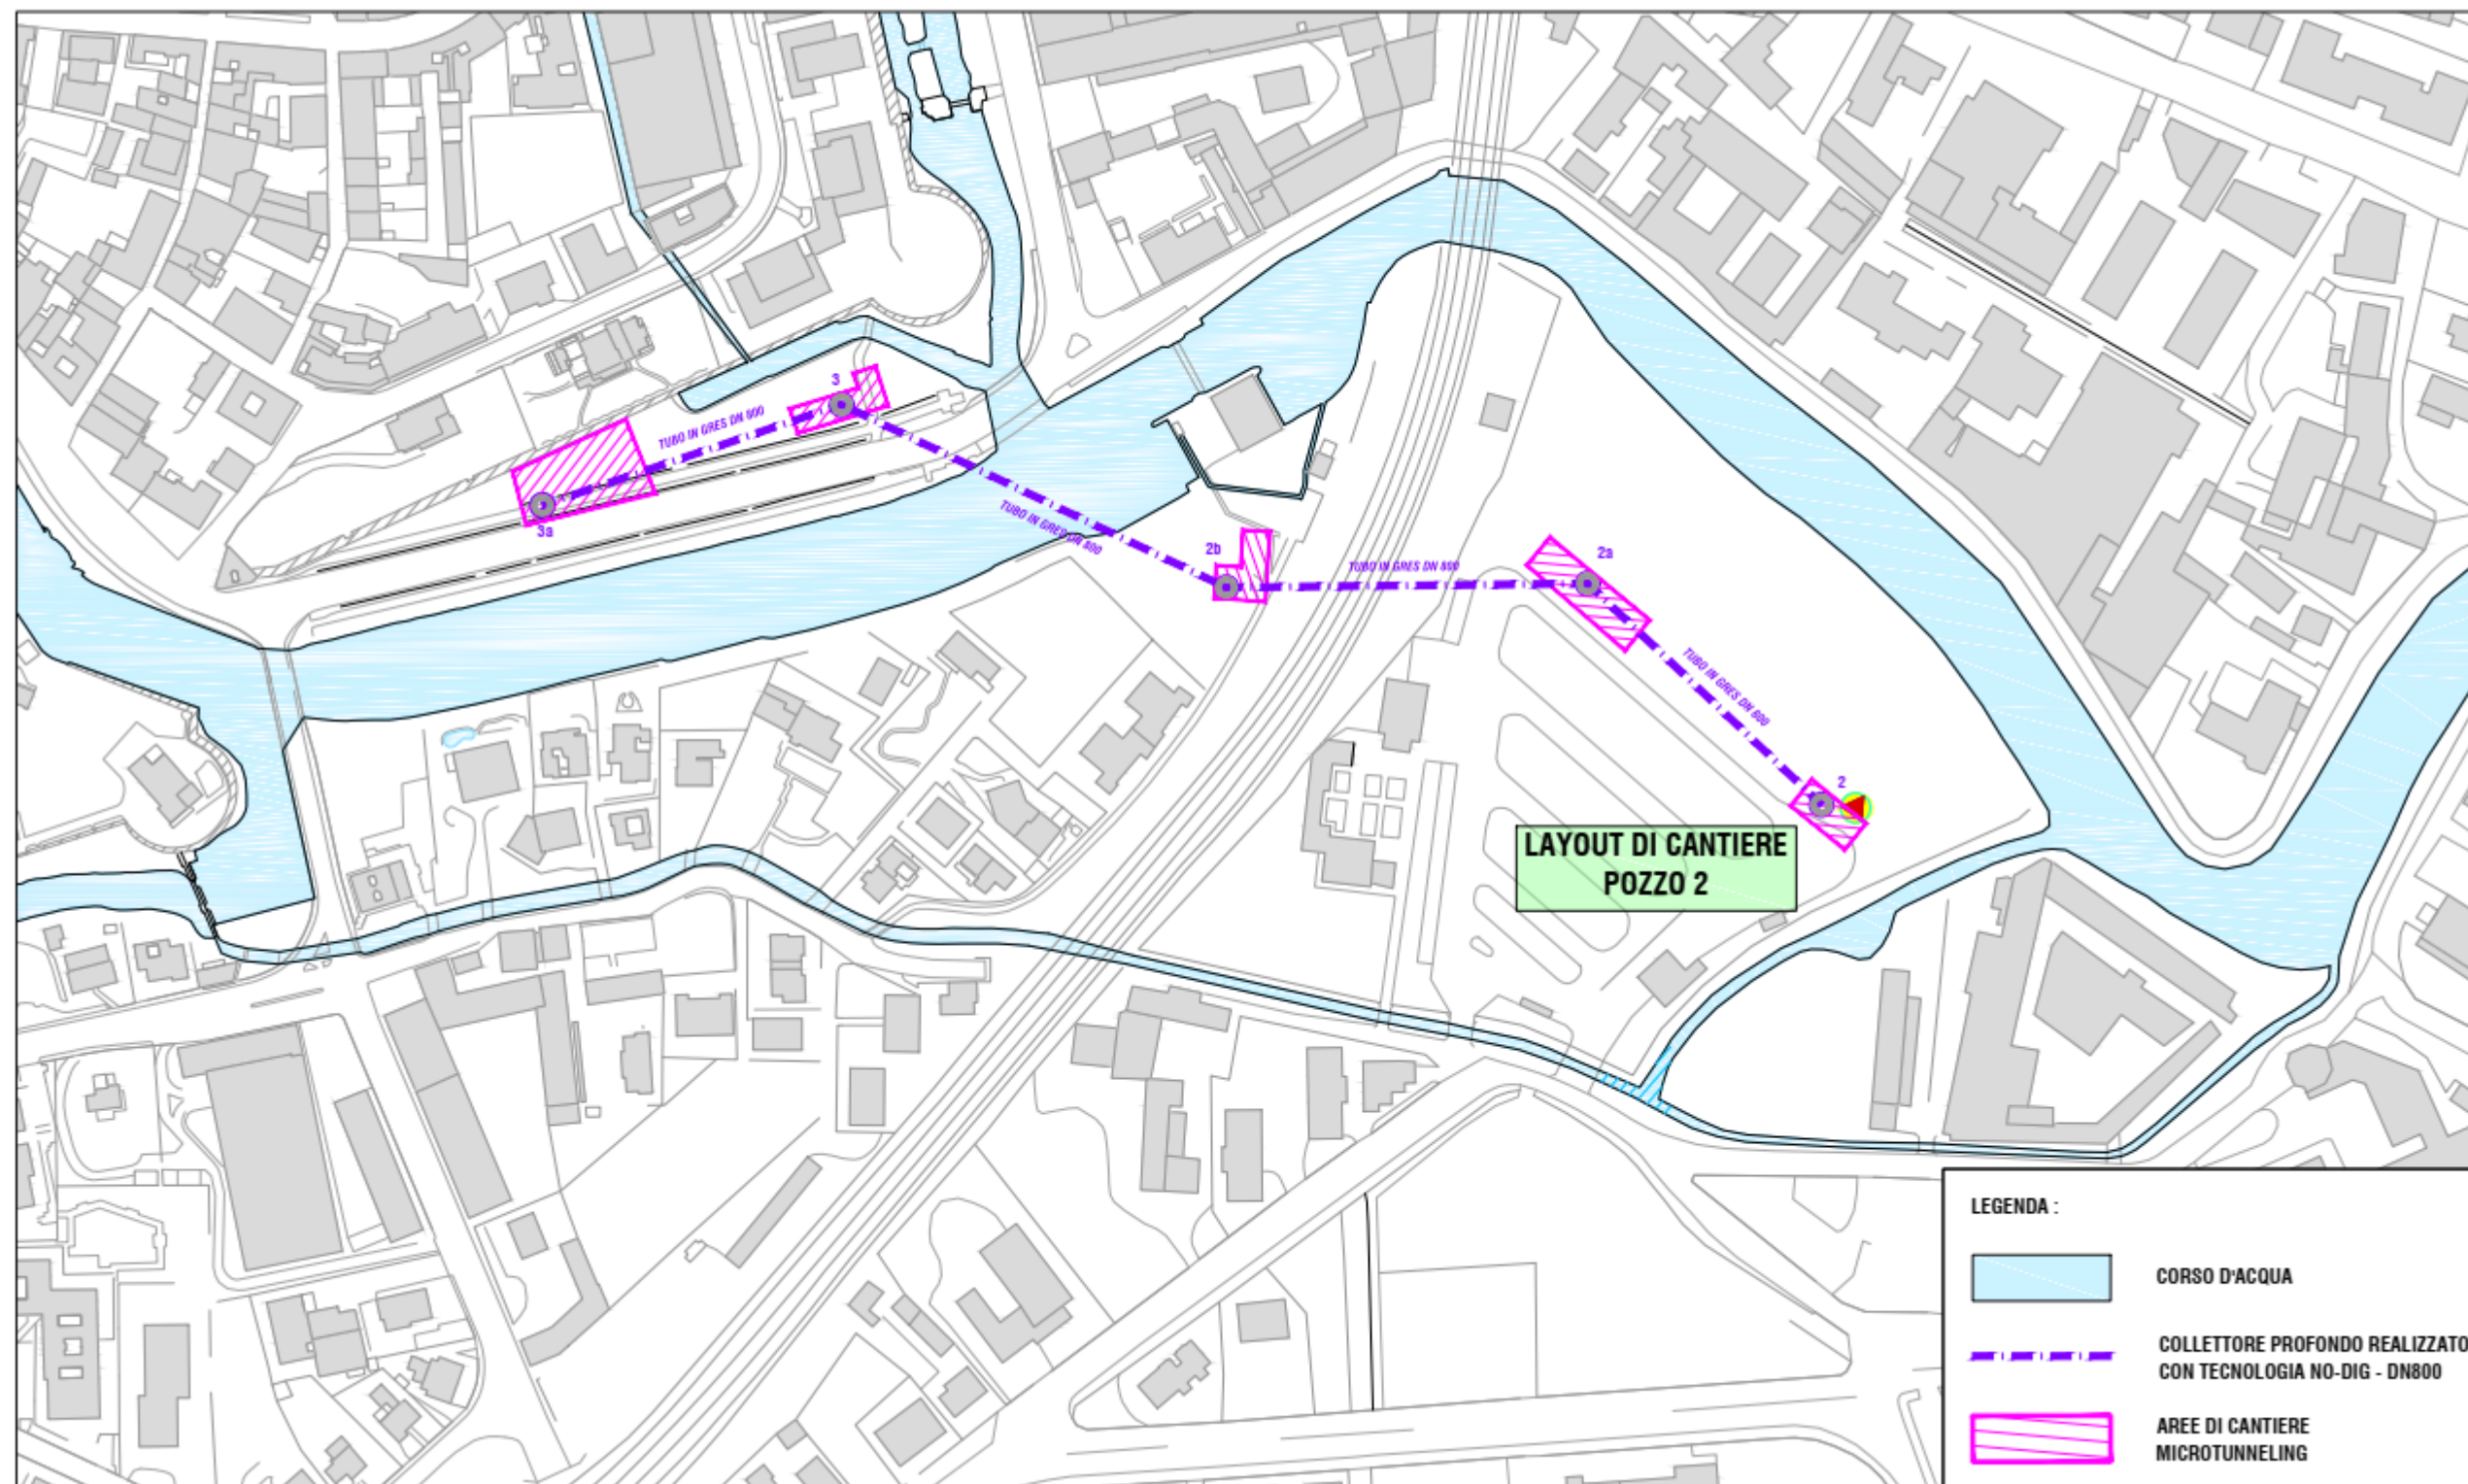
I : Inquadramento planimetrico area cantiere POZZO S02
